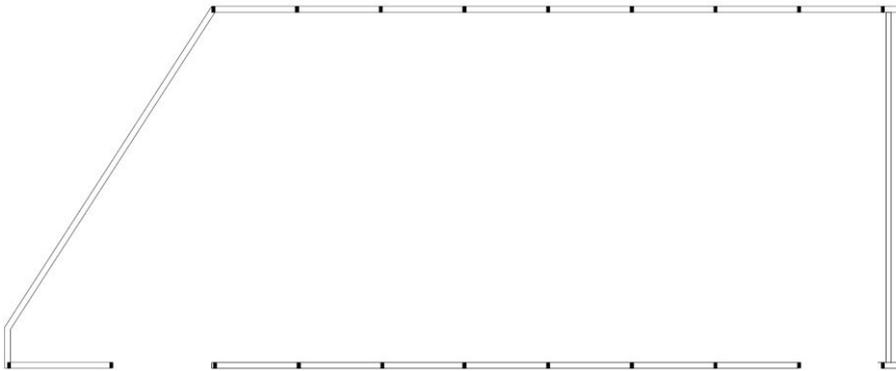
Grundriss Betriebshalle 3 (Projekt B)⁴⁵⁰
